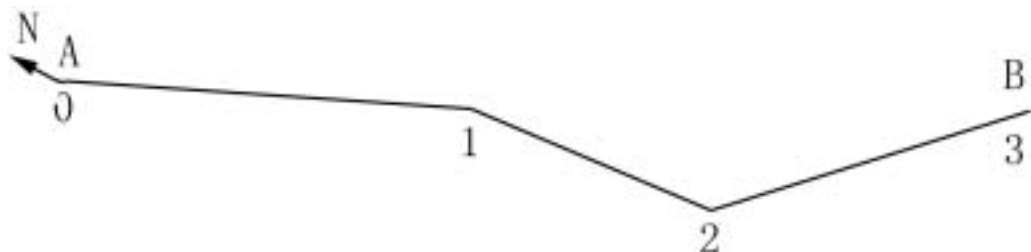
3 导线平面图 (1 : 1000 ; 未画完)
